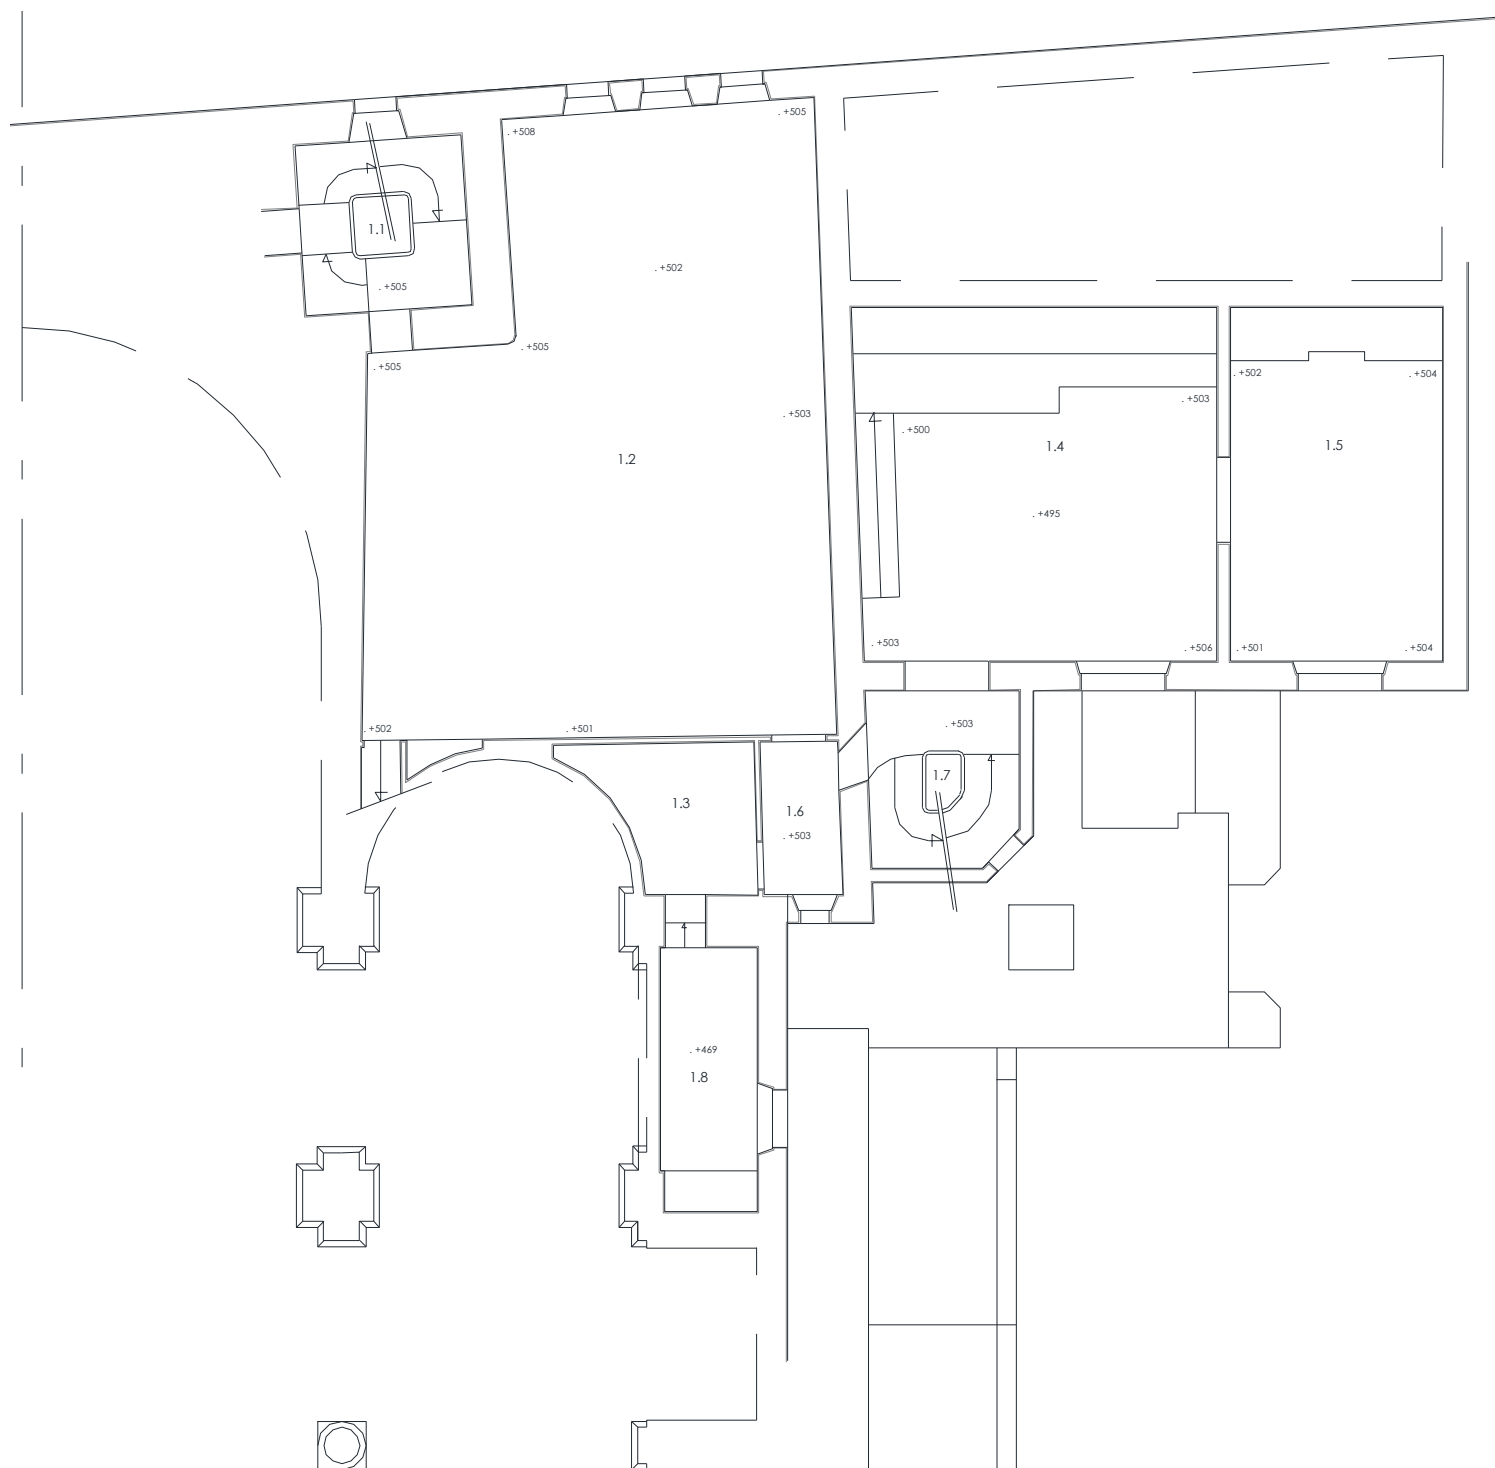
Vue en plan du Premier étage - Extrait plan Architect-On - Numérotation des salles (1.1 à 1.8)
